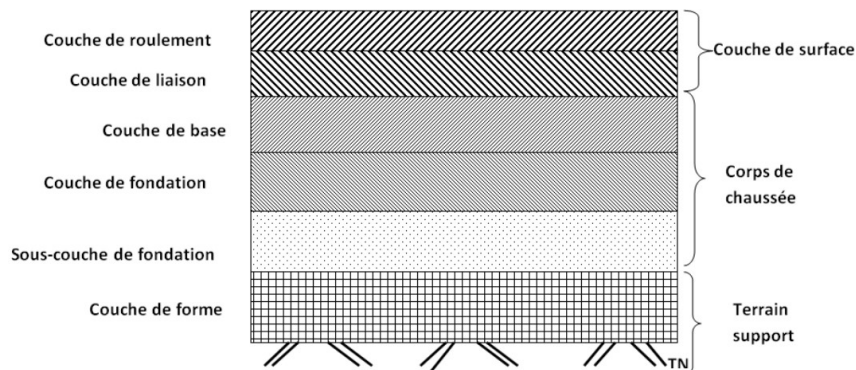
Différentes couches constituant la chaussée souple.
